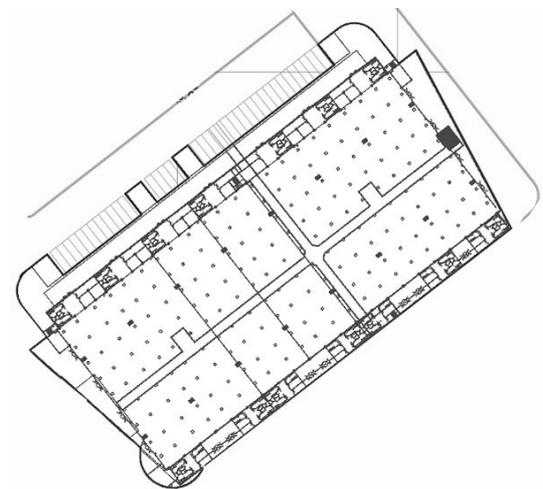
Planta do pavilhão de feiras (fonte: SEINFRA).
